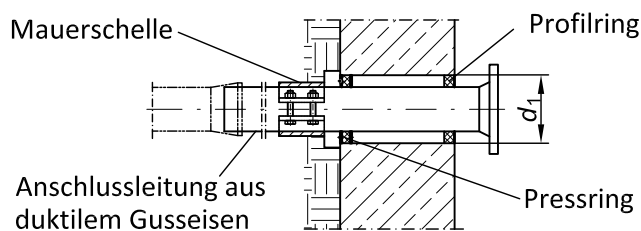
Detail X: Wanddurchführungen am Wasserzählerschacht
